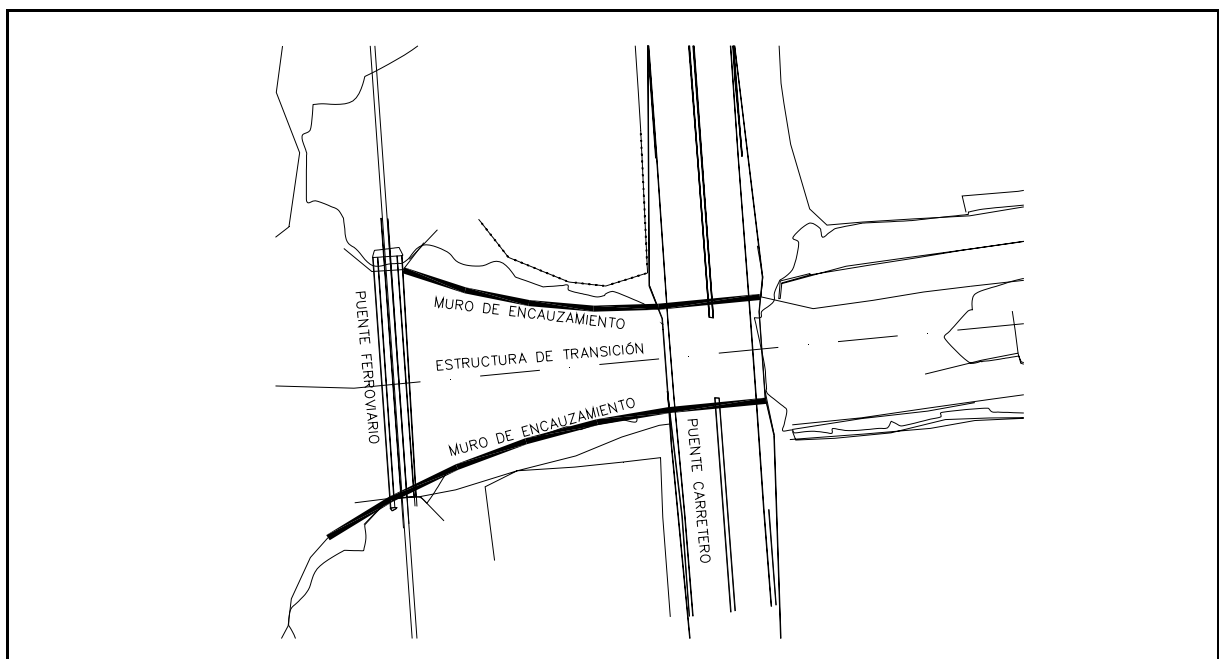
Plano en planta de ampliación del puente carretero , ancho 22 m y muro entre puentes
